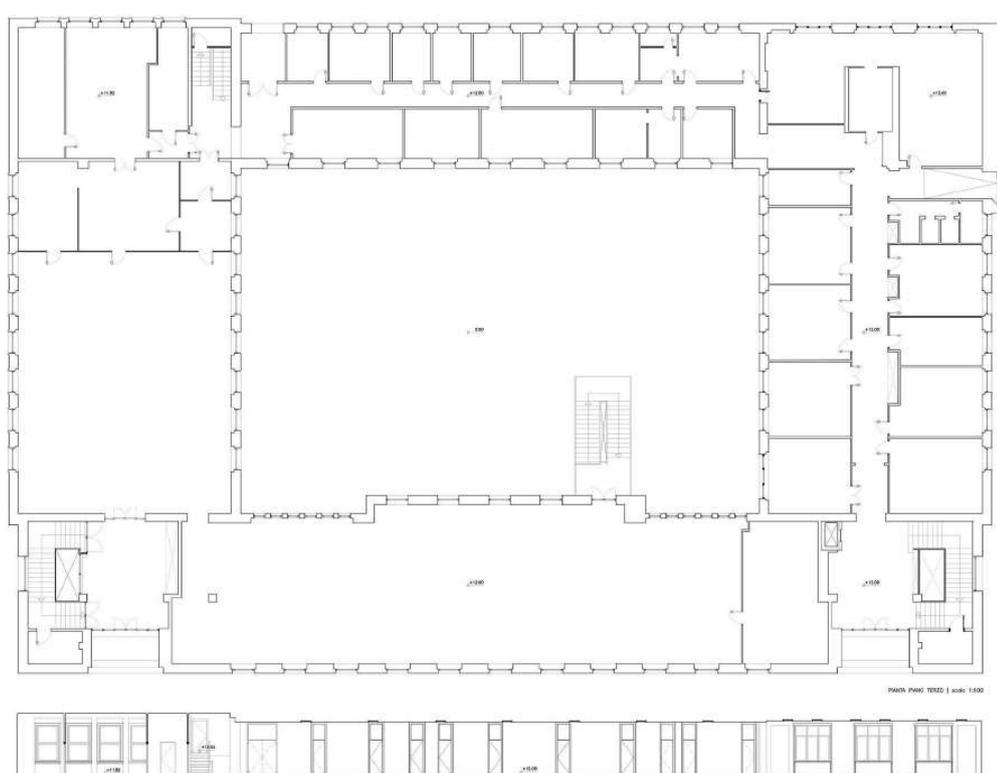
Restituzione della pianta del piano terzo e di una sezione dell'edificio di Geologia. Vedi nota 1 sulla proprietà delle immagini.
